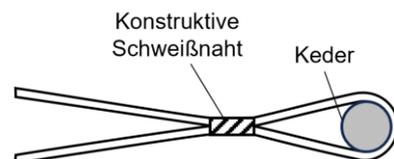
Kedertasche mit konstruktiver Schweißnaht
